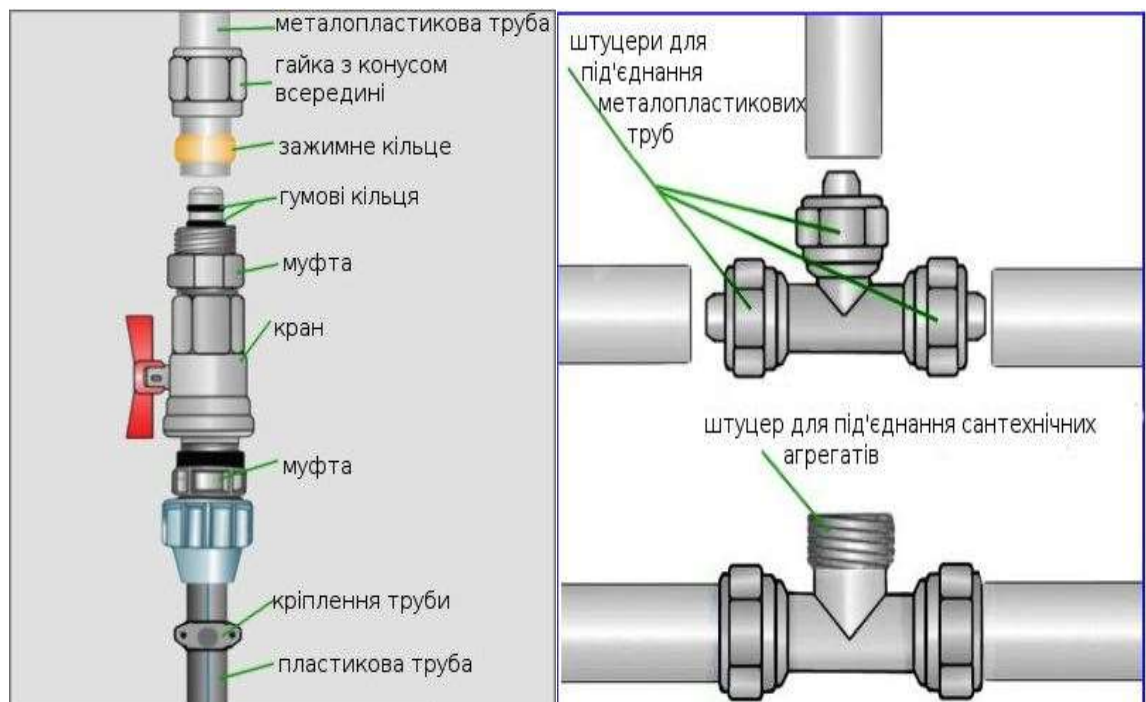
Схеми з'єднань елементів метало-пластикових труб
